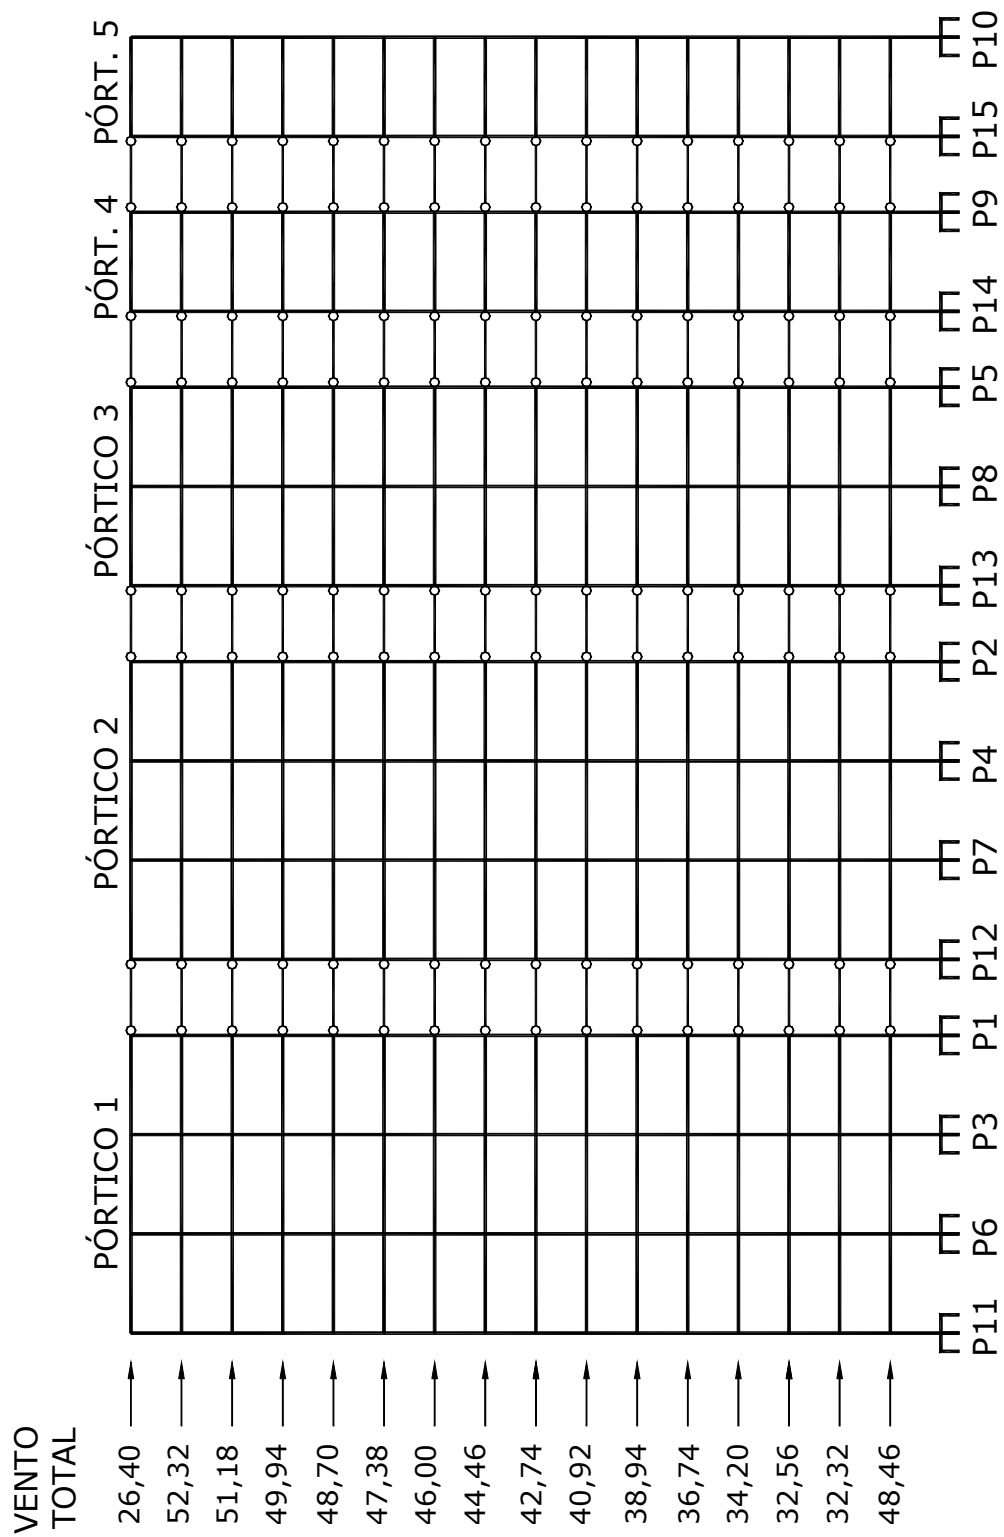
Modelo Pórticos Planos Alinhados (PPA) da Estrutura 4: elevação dos pórticos e esquema do carregamento (em kN).
